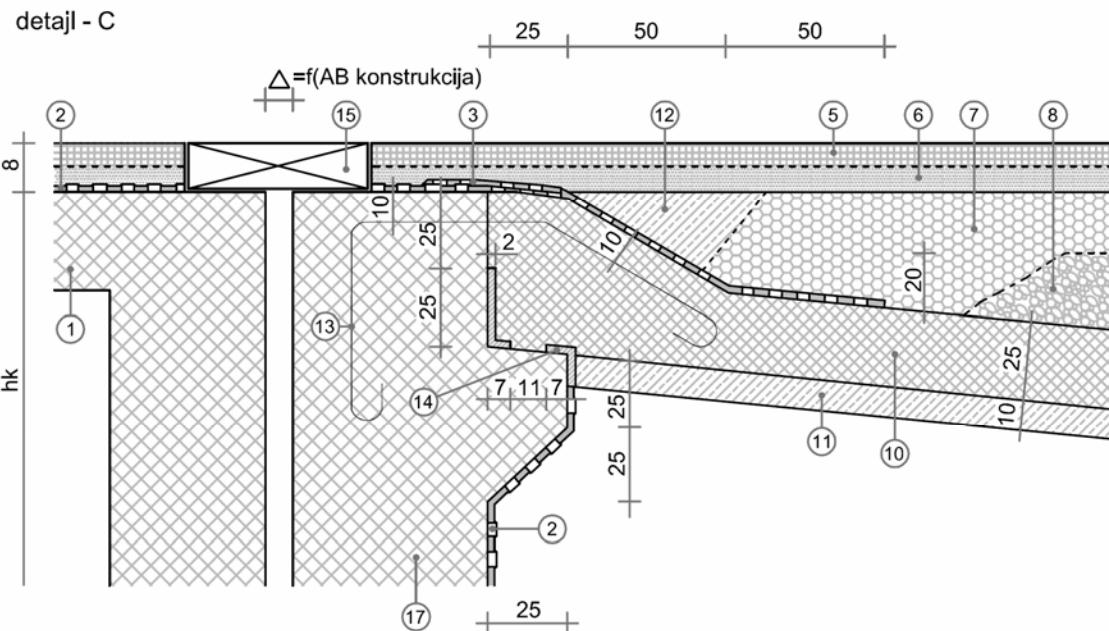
Detajl nalijeganja i vrha prelazne ploče kod okvirnih AB konstrukcija kada je center pomjeranja udaljen 30 – 50 m
